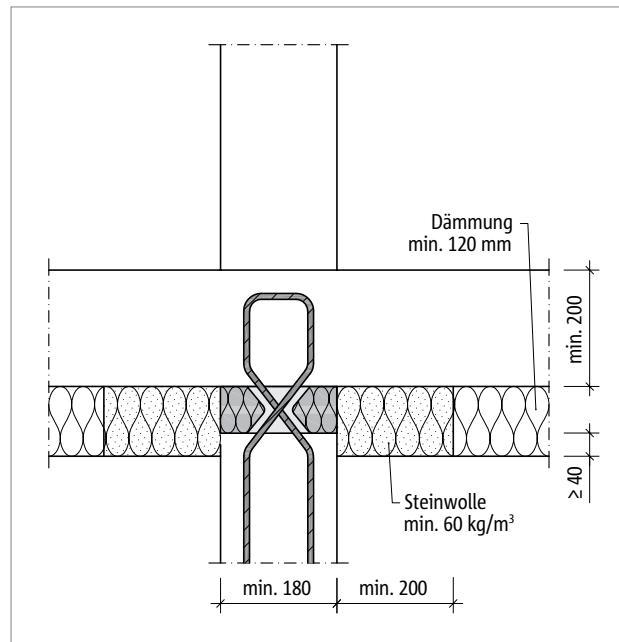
Schöck Sconnex® Typ W: Mit Randstreifen aus Steinwolle im Bereich der Unterdeckendämmung
